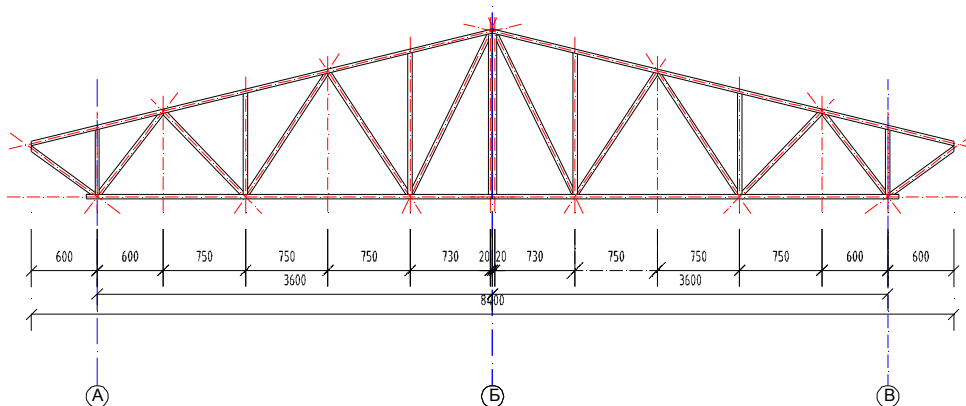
Конструктивные решения стеновых панелей и ферм покрытия
